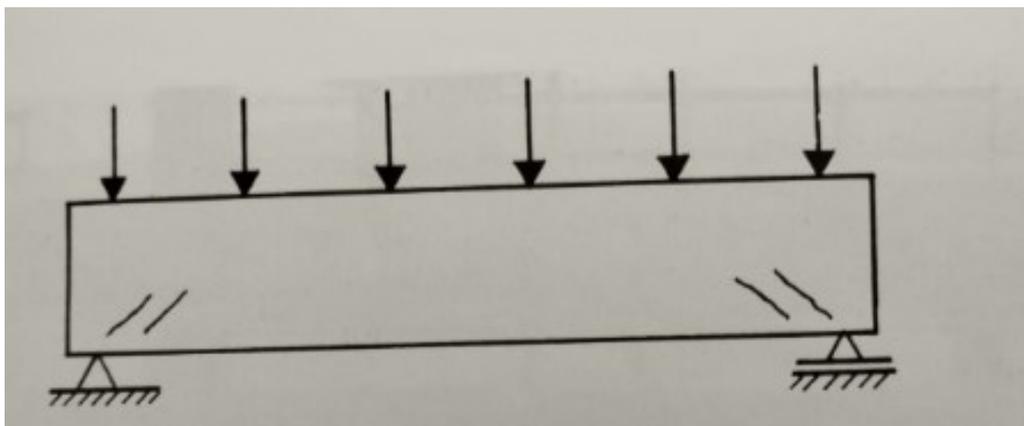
Representação de fissura típica em vigas subarmadas solicitada à flexão.
